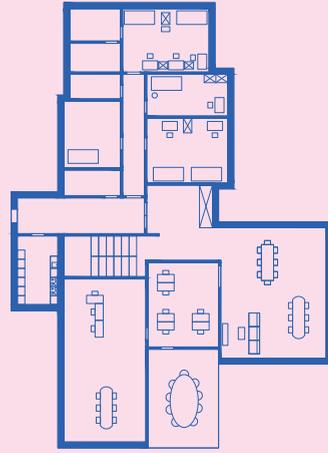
Plan du Foyer Sainte Famille, 1er, 1:500, 2022
